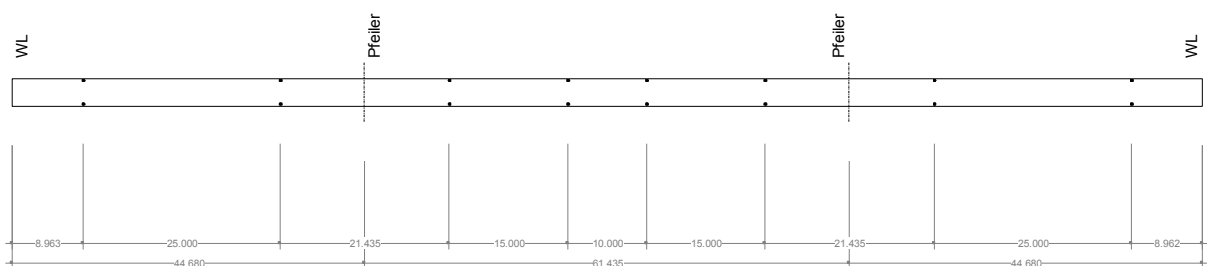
Lage der Entwässerungen (Draufsicht Brückenträger)
